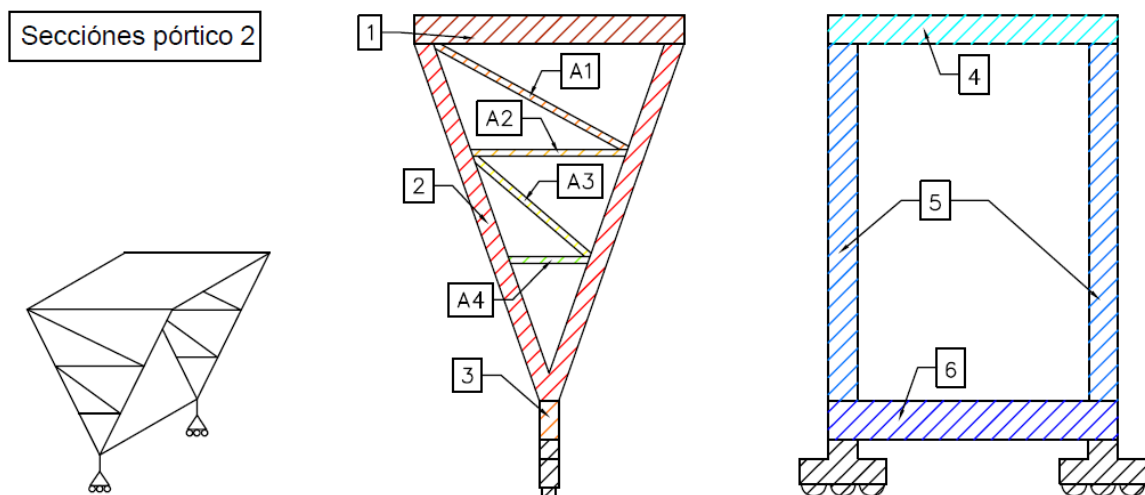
Secciones numeradas para aplicación del viento. Pórtico 2.
